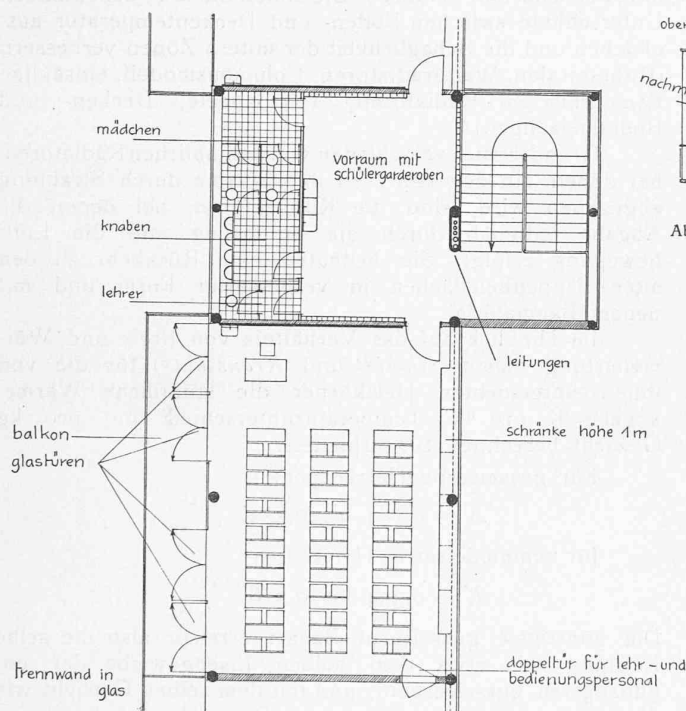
Entwurf Freiluftschule A. Roth, Grundriss des Systems 1 : 200. Beispiel für eine bauliche Anordnung, die sowohl grundrisslich als auch betrieblich nur durch die Deckenheizung ermöglicht wird.
